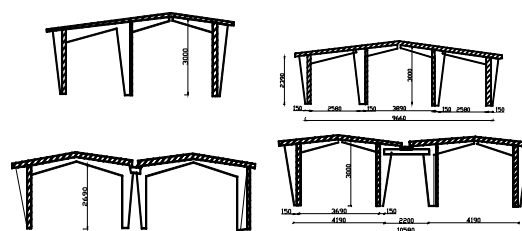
Схема номенклатуры зданий с рамными конструкциями фирмы Krölbau (дачный дом, жилой дом, общественное, производственное здание, гостиница; торговое помещение)
